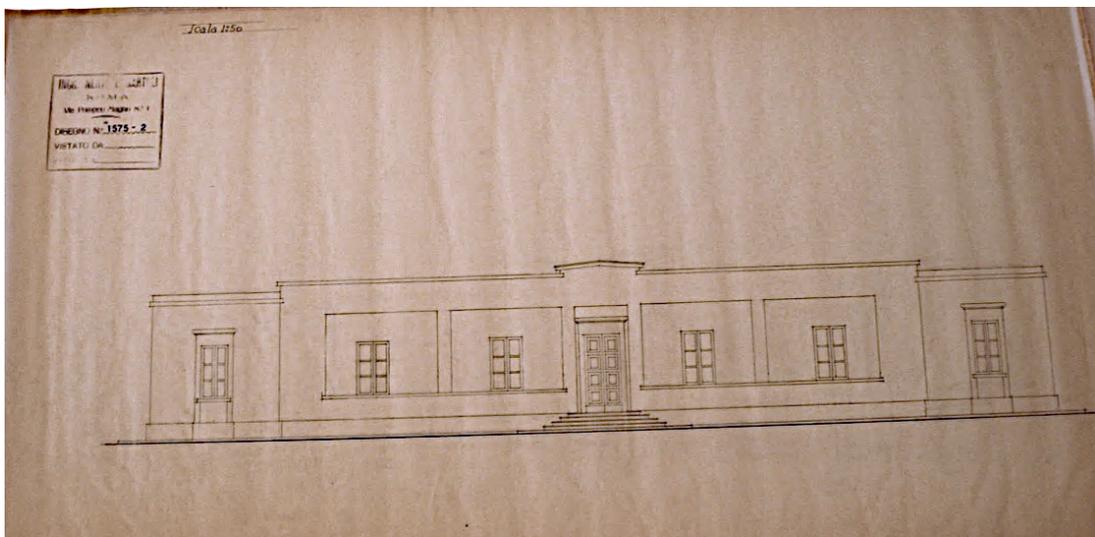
Prospetto e planimetria Casermetta, Aplermo, s.d. CSAC, fondo Nervi
